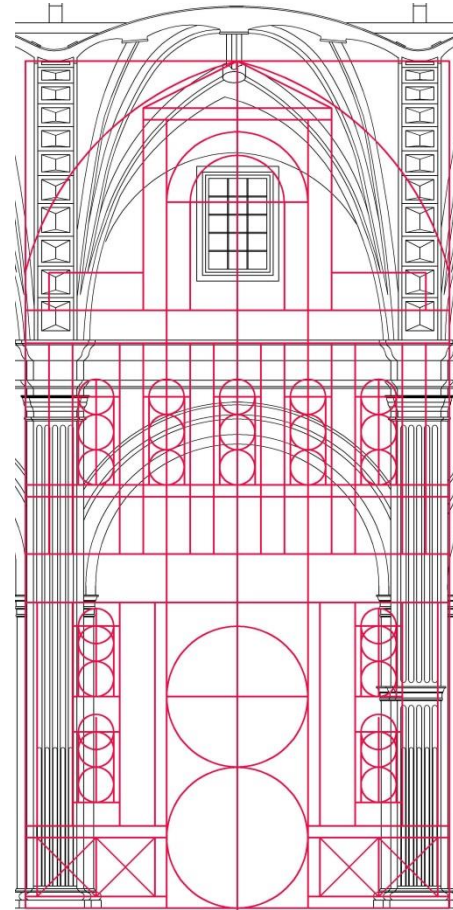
Esquema fachada retablo sobre alzado interior.
